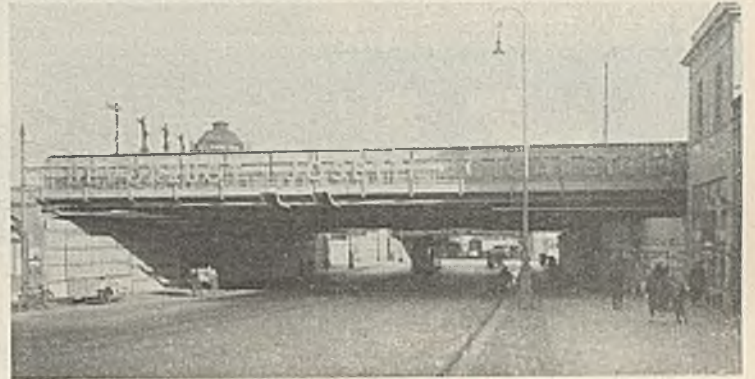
Unterführung der Delitzscher Straße in Halle.
